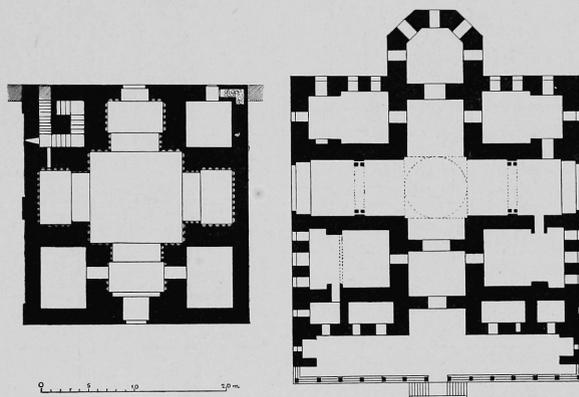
Links: Palastgrundriß von Ama'an. Rechts: Grundriß der Tschinilikiosk zu Stambul.
